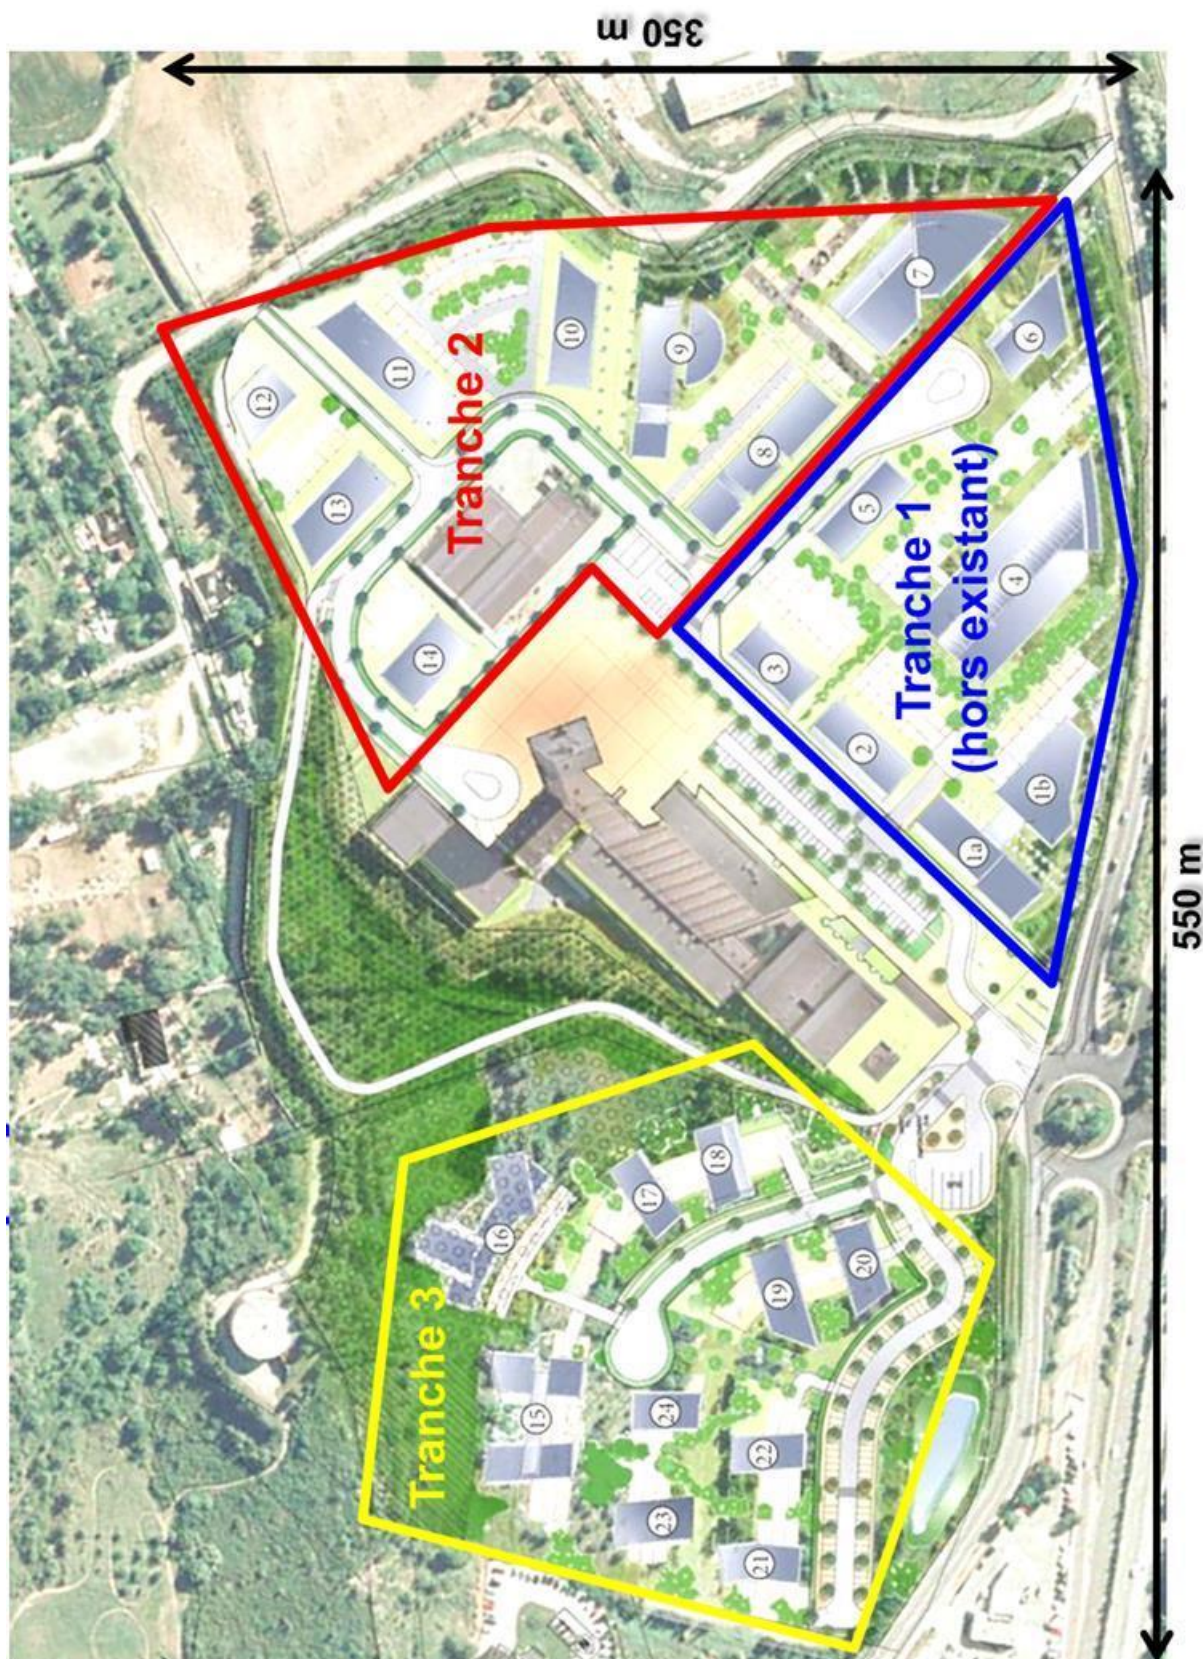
Délimitation des tranches d'aménagement et des possibles constructions
